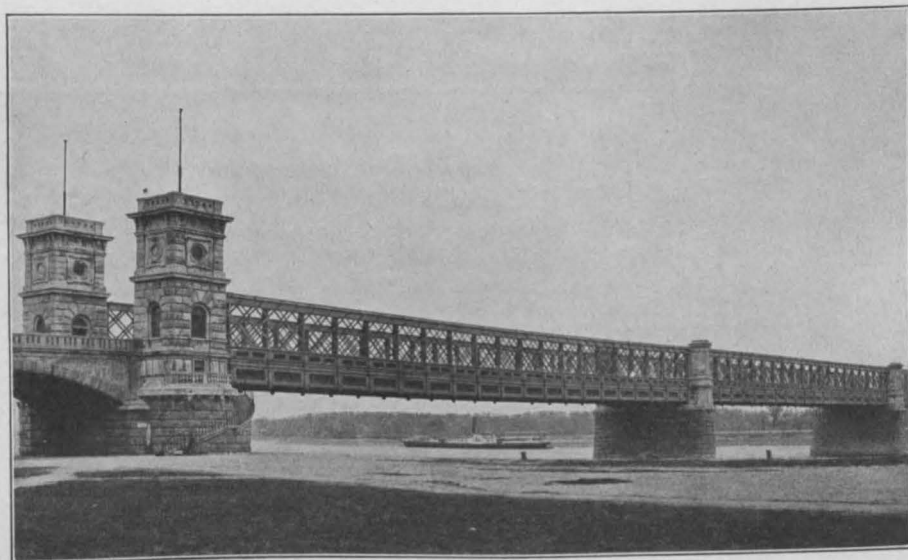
Kronprinz Rudolf-Strassenbrücke über den Donaukanal in Wien. 1872—1876.
